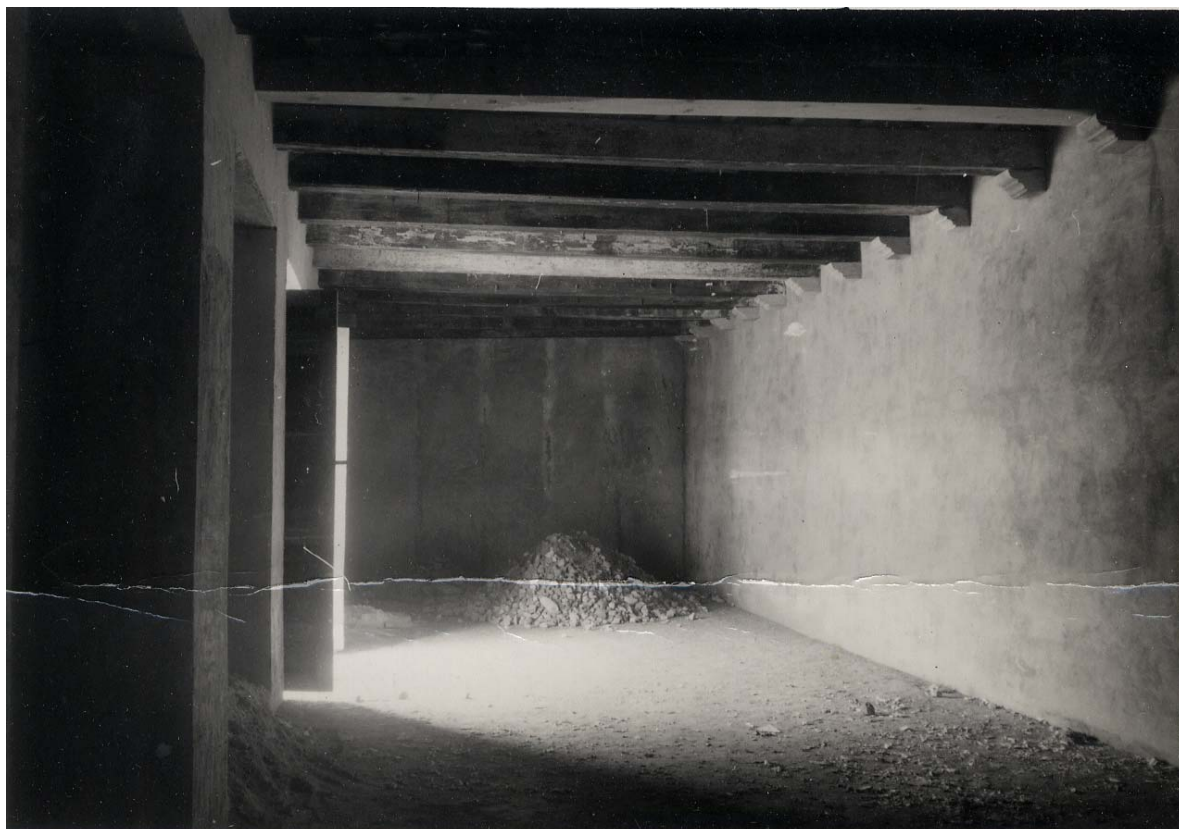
Interior de la planta baja de la Casa del Pópulo. Estado de las obras.
